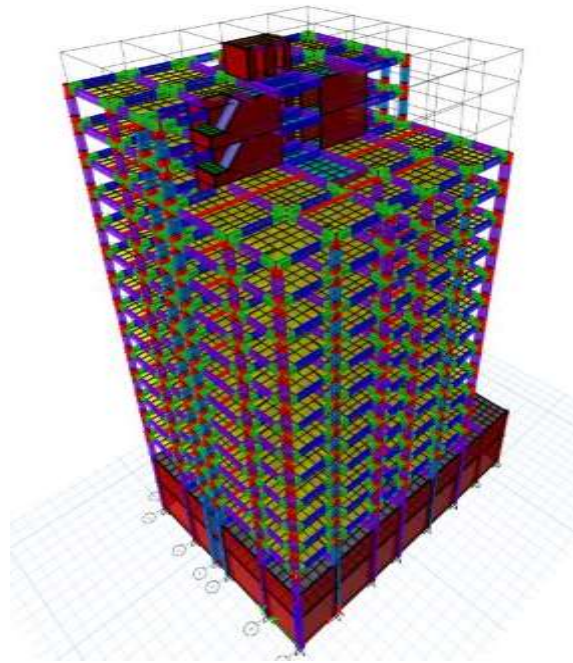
Modelo del Edificio de 14 pisos reforzado con perfiles metálicos tubulares rectángulos
